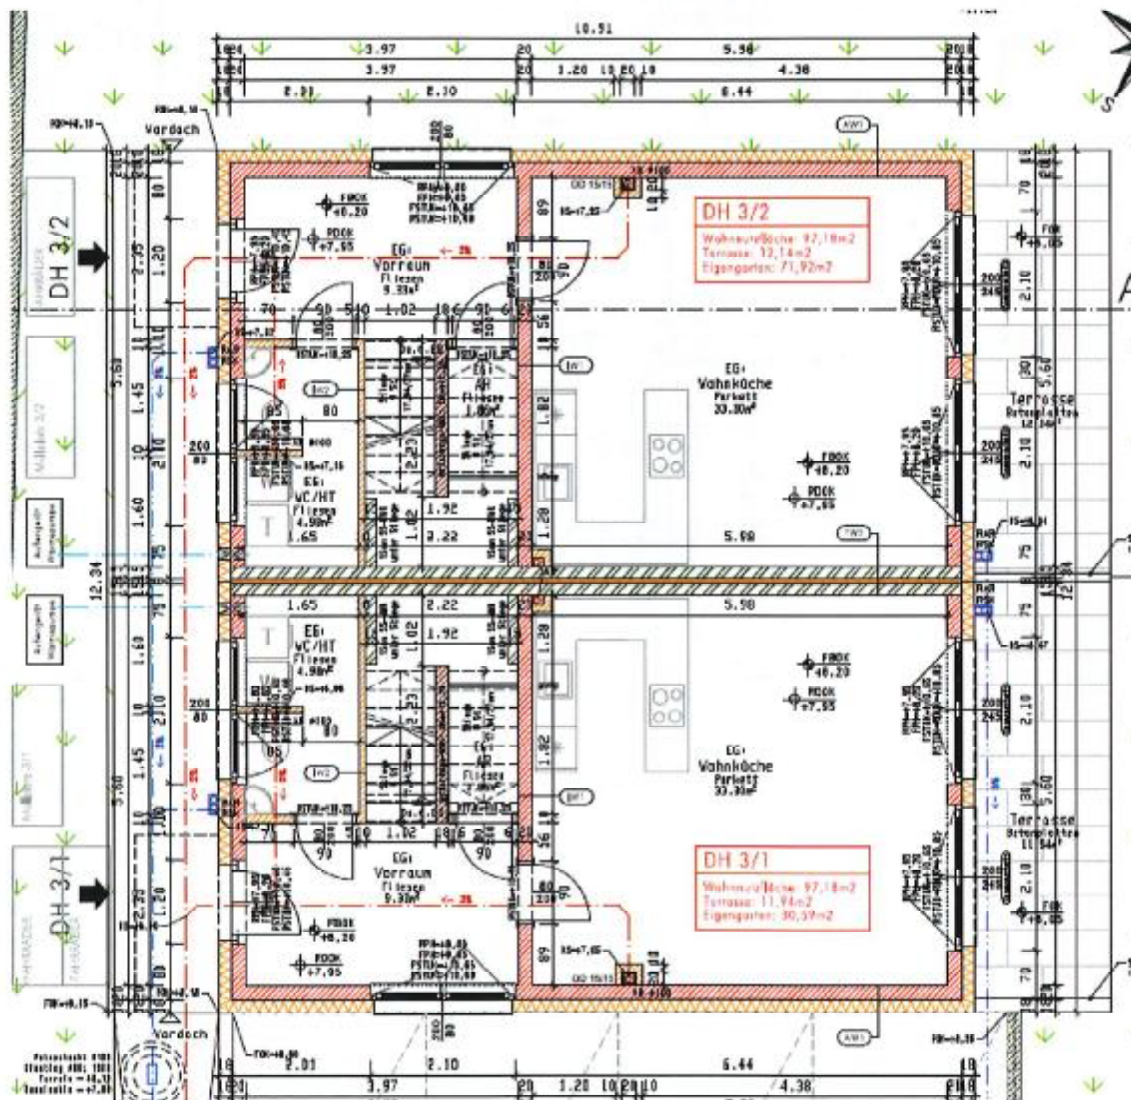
Grundriss Erdgeschoß Doppelhaus 3 | Ing. Rupert Weber | 23.11.2020
